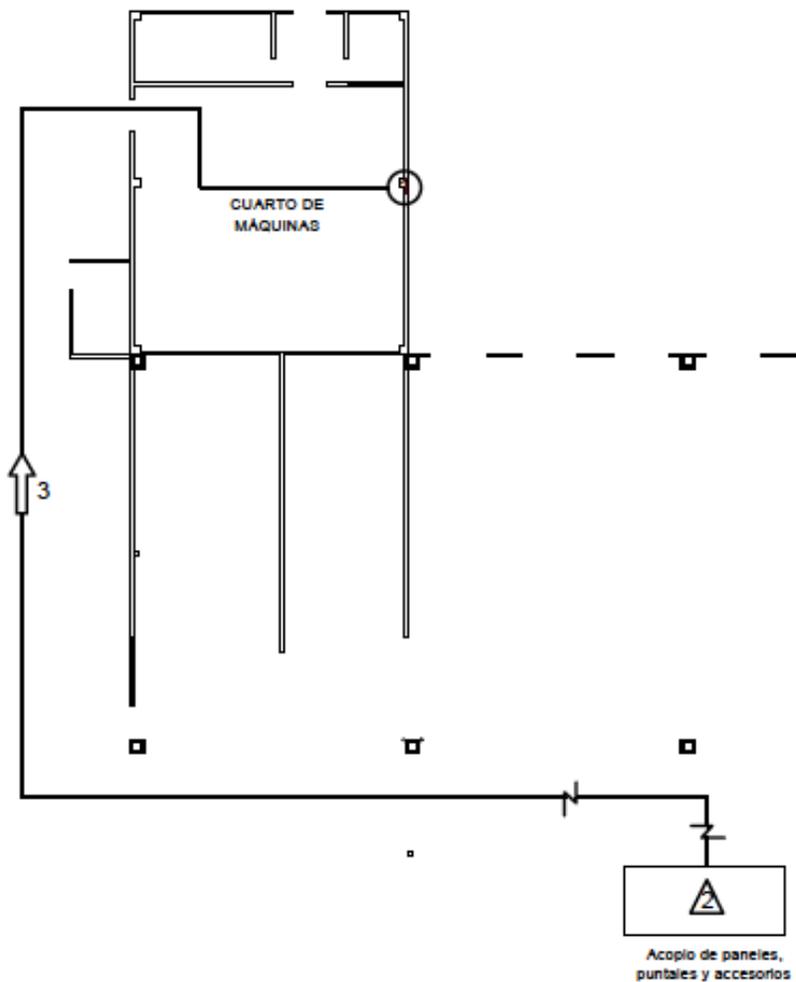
Productividad de encofrado de columnas, Muestra #3.
